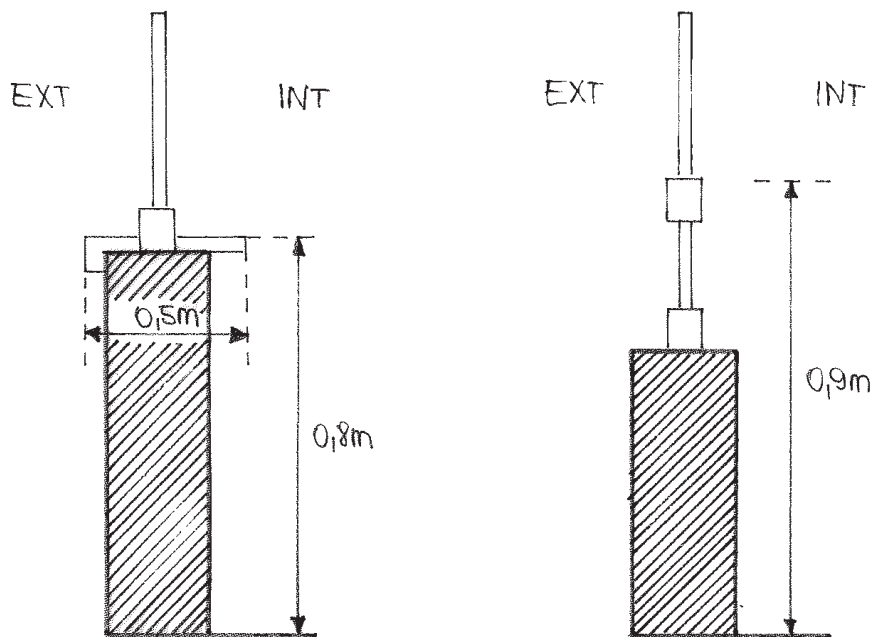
Hauteur des garde-corpsFigure 13 Géométrie des garde-corps (entraxe entre barreaux verticaux et dispositif empêchant d'y grimper)Art. 41 Allèges de fenêtres
